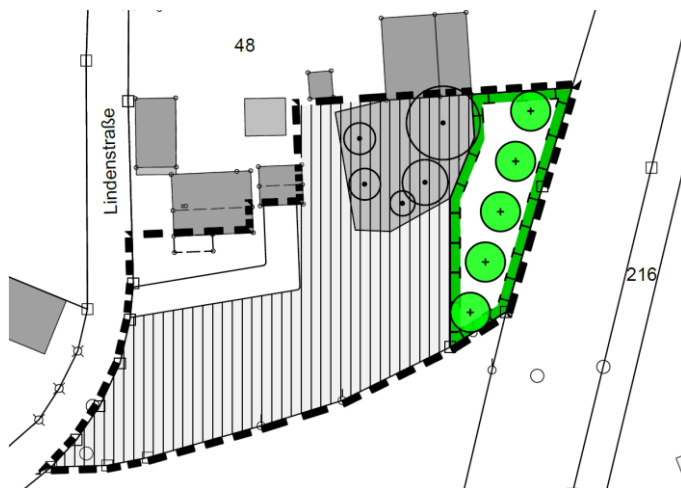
Plandarstellung der Eingriffsflächen unmaßstäblich, Eingriffsflächen grau hinterlegt, schwarz schraffiert, grüne T-Linie - Ausgleichsflächennachweis
